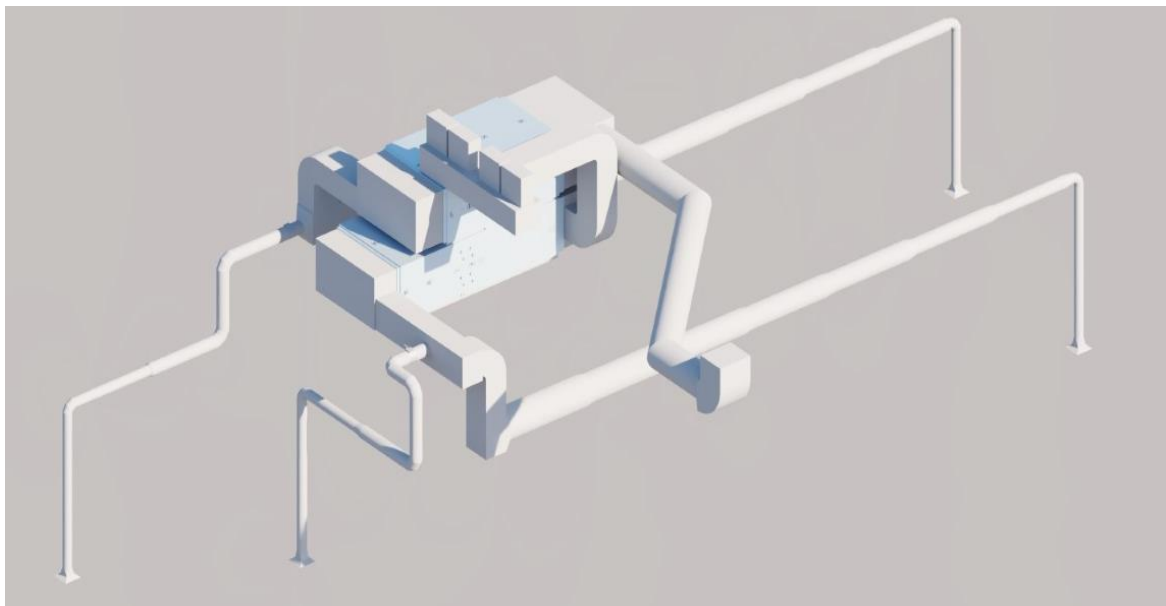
Фрагмент системы вентиляции жилого дома
